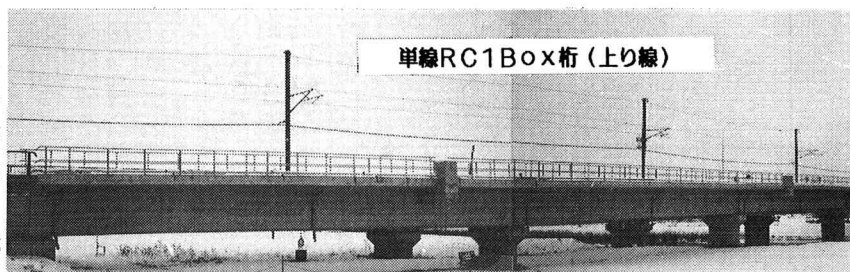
馬見ヶ崎川B（流動化膨張コンクリート打設）
